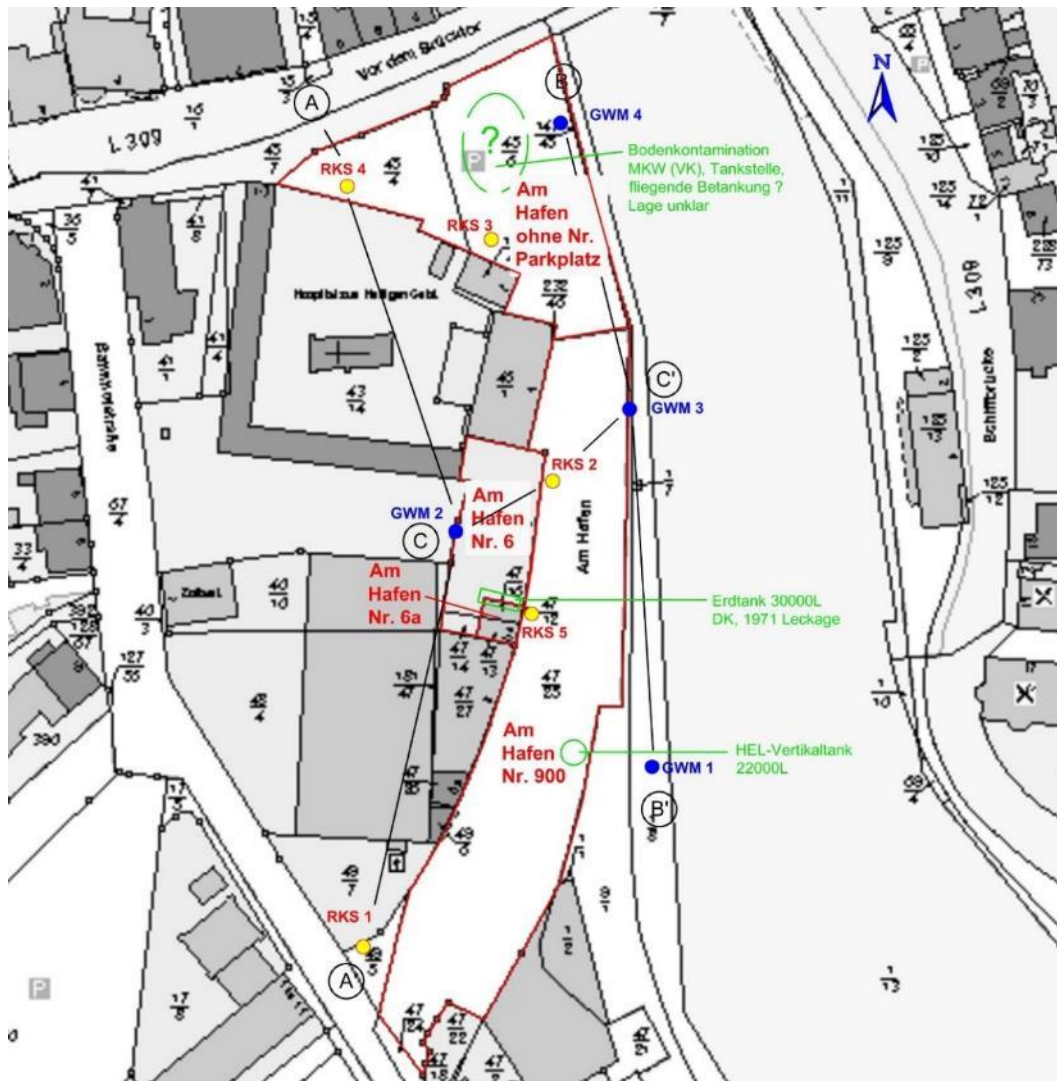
Lageplan der orientierenden Untersuchung vom 25.06.2019, BRUG GmbH mit Kennzeichnung alllastenverdächtiger Flächen (rot), Rammkernsondierung mit Ausbau zu Grundwassermessstelle GWM (blau) und Rammkernsondierung (gelb), ohne Maßstab
